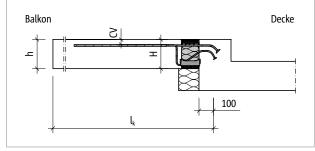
Schöck Isokorb® XT Typ K-U: Statisches System
